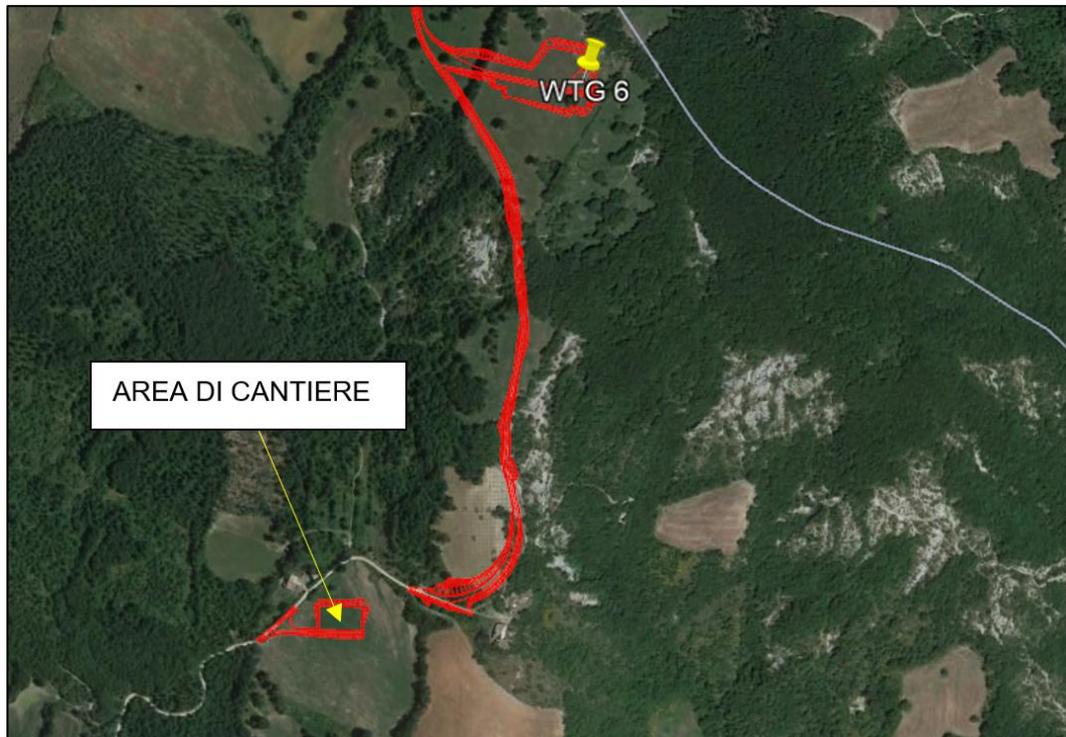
Posizionamento dell'area esterna di cantiere temporanea
